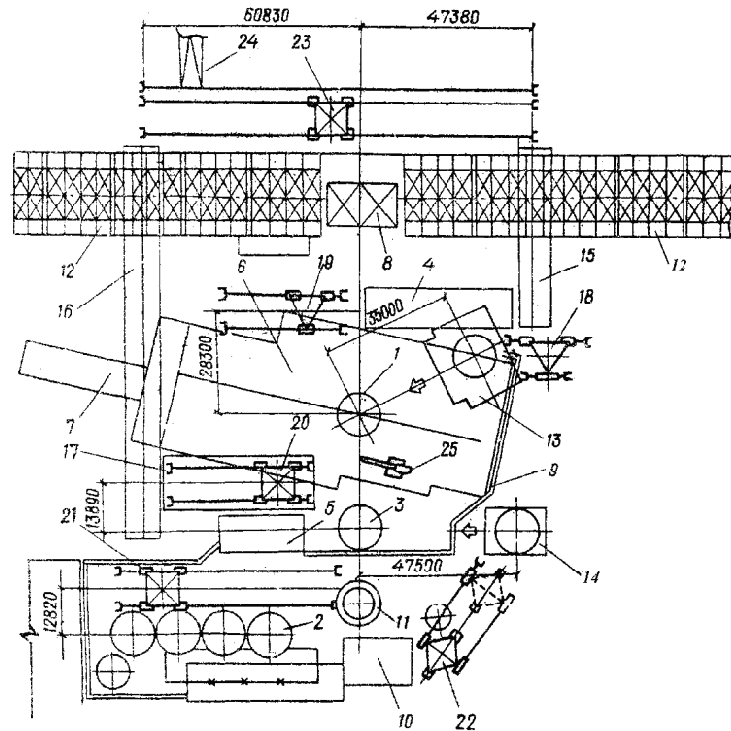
Схема монтажной площадки доменной печи № 4: 1 – доменная печь; 2 – воздушонагреватели; 3 – пылеуловитель; 4 – мазгал; 5 – КНП; 6 – литейный двор; 7 – вытяжная станция литейного двора; 8 – скиповая яма; 9 – кабельная галерея; 10 – здание ЦВС и фильтронасосной; 11 – скруббер; 12 – бункерная эстакада; 13 – стенд для сборки доменной печи; 14 – стенд для сборки пылеуловителя; 15 – передаточная эстакада № 1; 16 – передаточная эстакада № 2; 17 – эстакада под кран; 18 – кран БК-1000 №1; 19 – кран БК-1000 № 2; 20 – кран БК-1000; 21 – кран БК-900; 22 – кран БК-300; 23 – кран БК-406М; 24 – козловой кран УСП-50-50; 25 – гусеничный кран СКГ-40.
